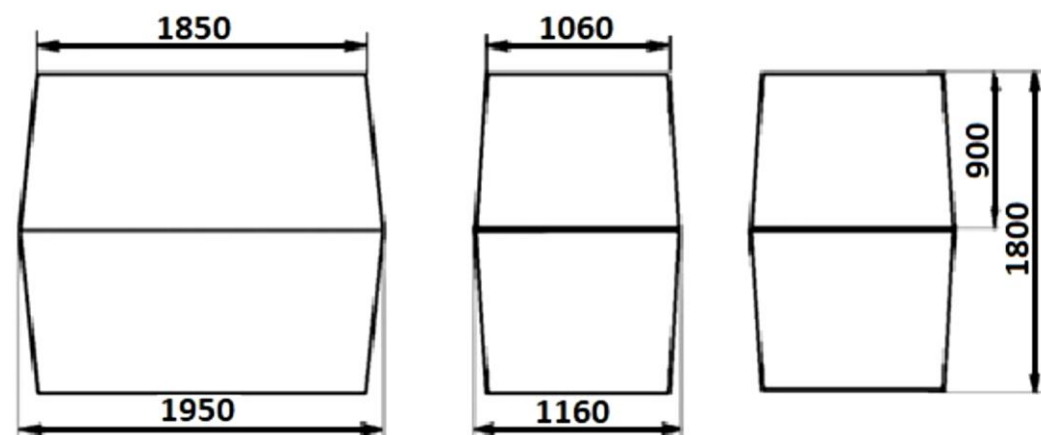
Габаритные размеры колодца «ККСр-3,5-10(80)» в сборе.
